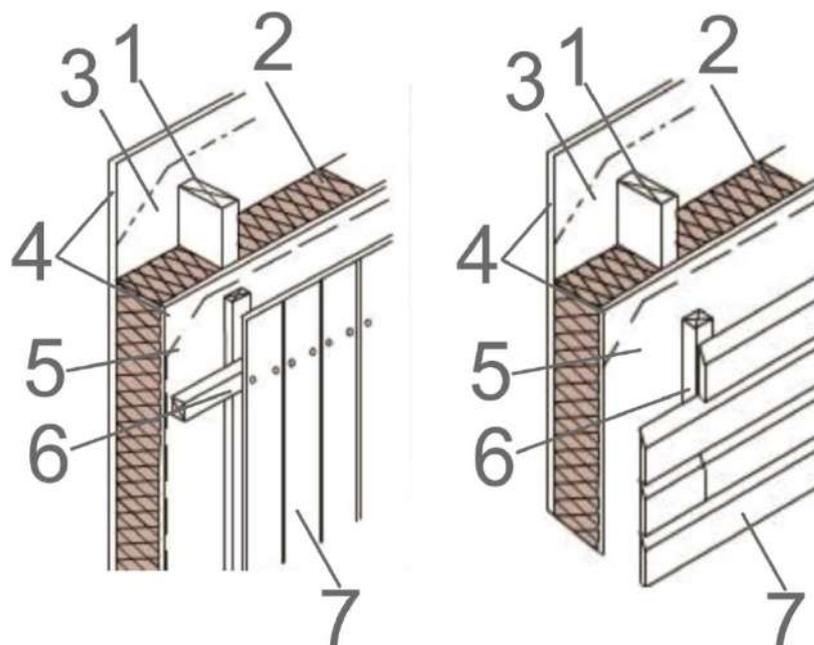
Схема конструкции стены с облицовкой фасада планкеном
